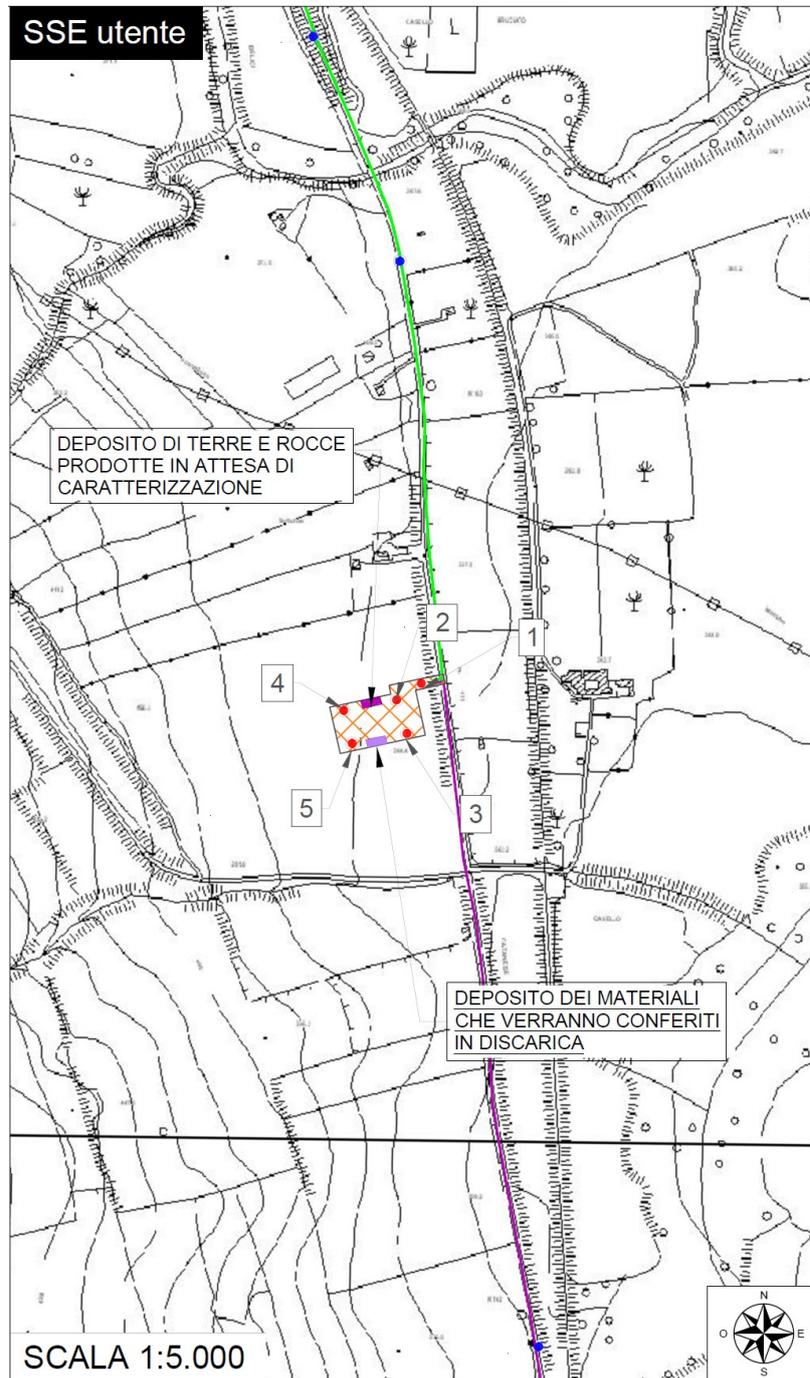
Planimetria Sottostazione utente con punti di campionamento
